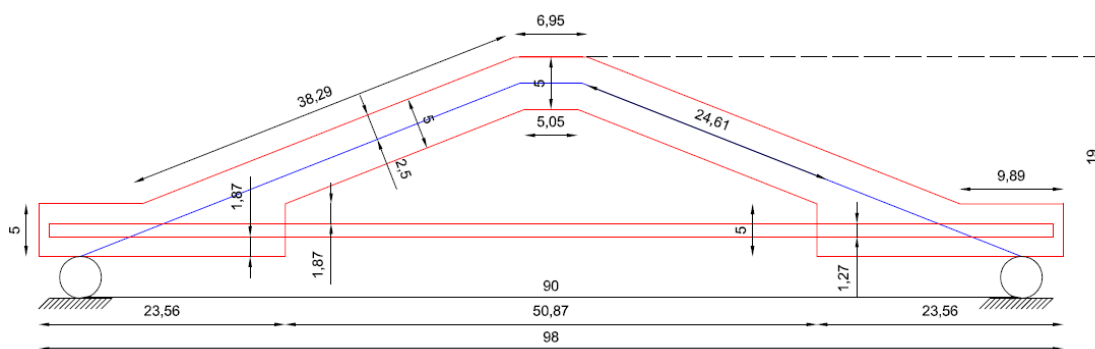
Esquema de la geometría escogida para la estructura tipo viga (dimensiones en cm).
